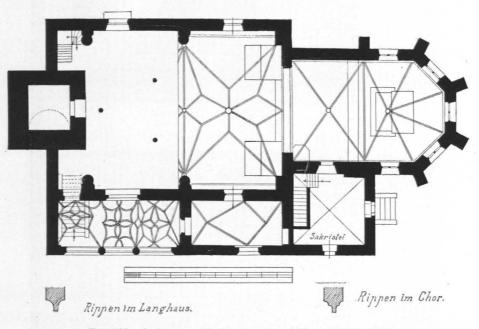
Anthering, Pfarrkirche, Grundriß 1:250 (S. 371)
